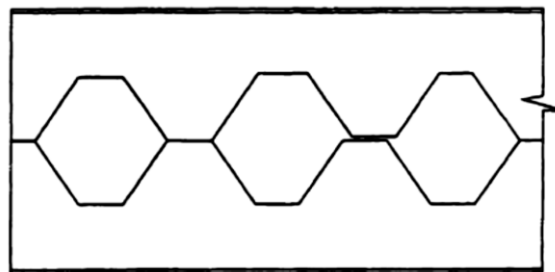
Ruine par rupture de la soudure du montant intermédiaire [11]
